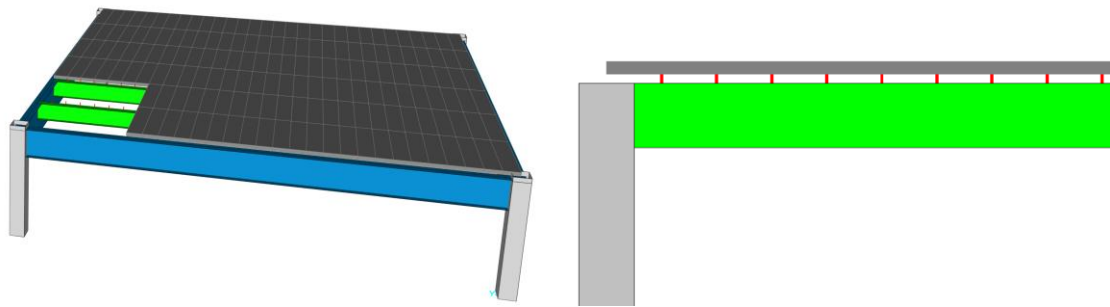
Ejemplo de modelado de la losa para que no participe en las vigas secundarias
